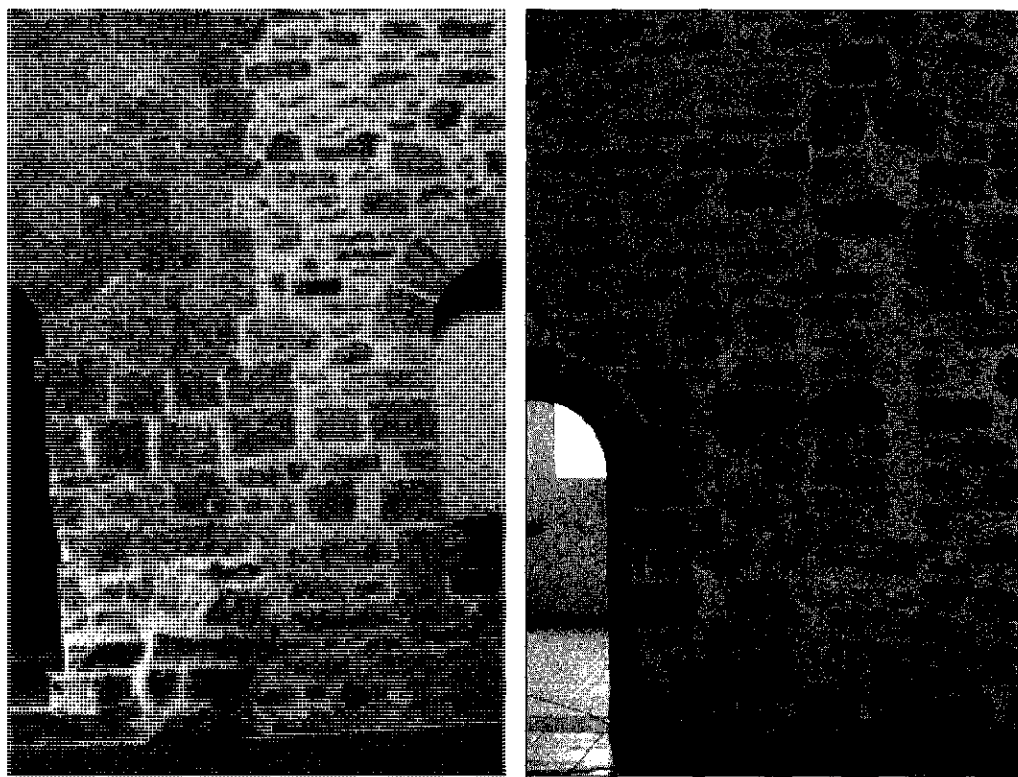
Vista del «corte» de las paredes norte y sur de la iglesia, tras de limpiar los muros por el interior: a) muro norte; b) muro sur.
